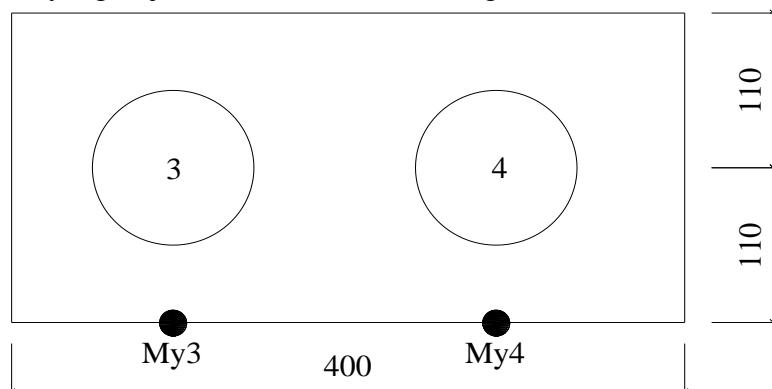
Arah pembebanan pondasi tiang bor pada poer (4 tiang)
